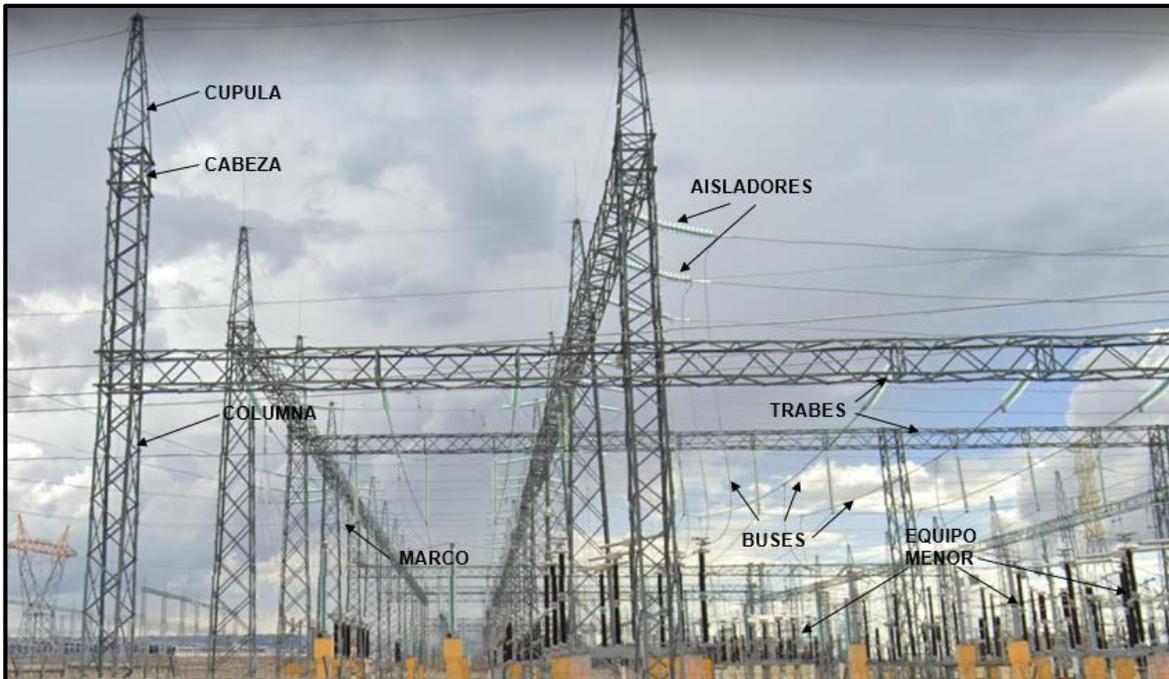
Estructura Mayor de acero ya montada en la Ampliación de la Subestación
